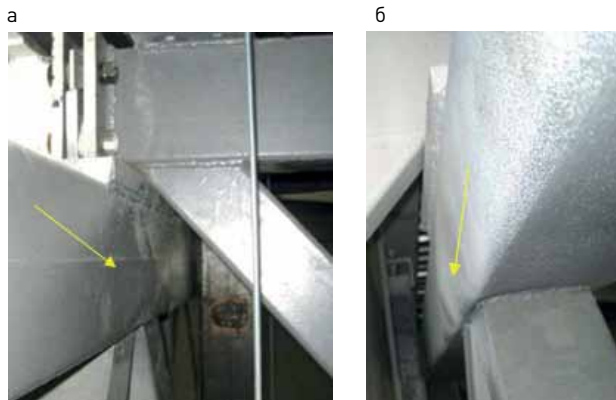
Потеря местной устойчивости стенок сечения верхнего пояса подстропильной фермы в месте опирания стропильной фермы Ф А-Б- 1/2 со стороны пролета А-Б (а) и со стороны пролета Б-В (б)
